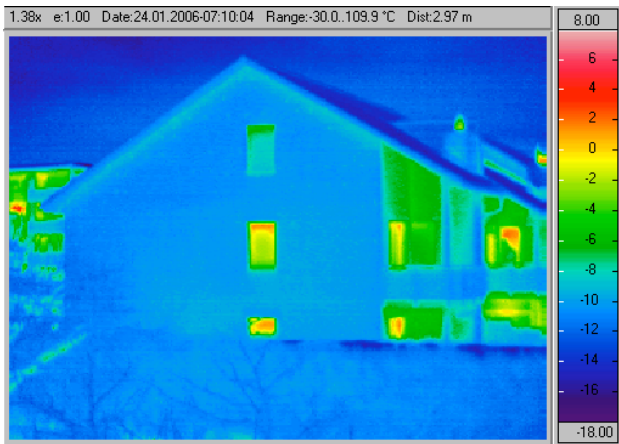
Gebäude mit verputzter Aussenwärmedämmung. Dargestellt ist der Temp.-Bereich -18 bis +8°C. Zu erkennen sind die leicht wärmeren Fassaden unter dem Vordach und dem Balkon (rechts). Das Vordach schützt dort die Oberflächen vor Unterkühlung.
